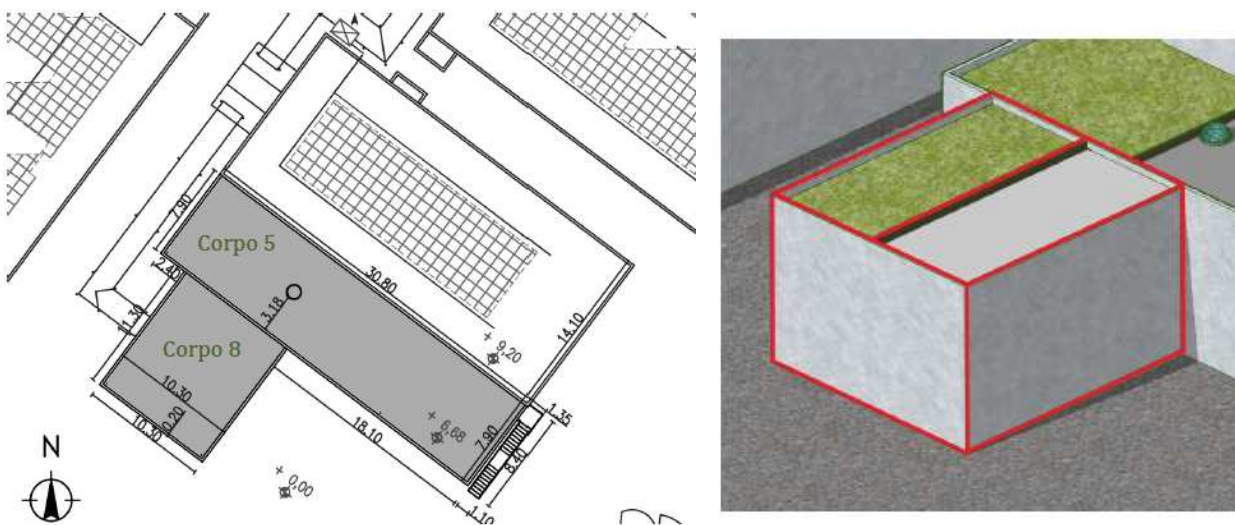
Planimetria e schema volumetrico del LAGIRN
